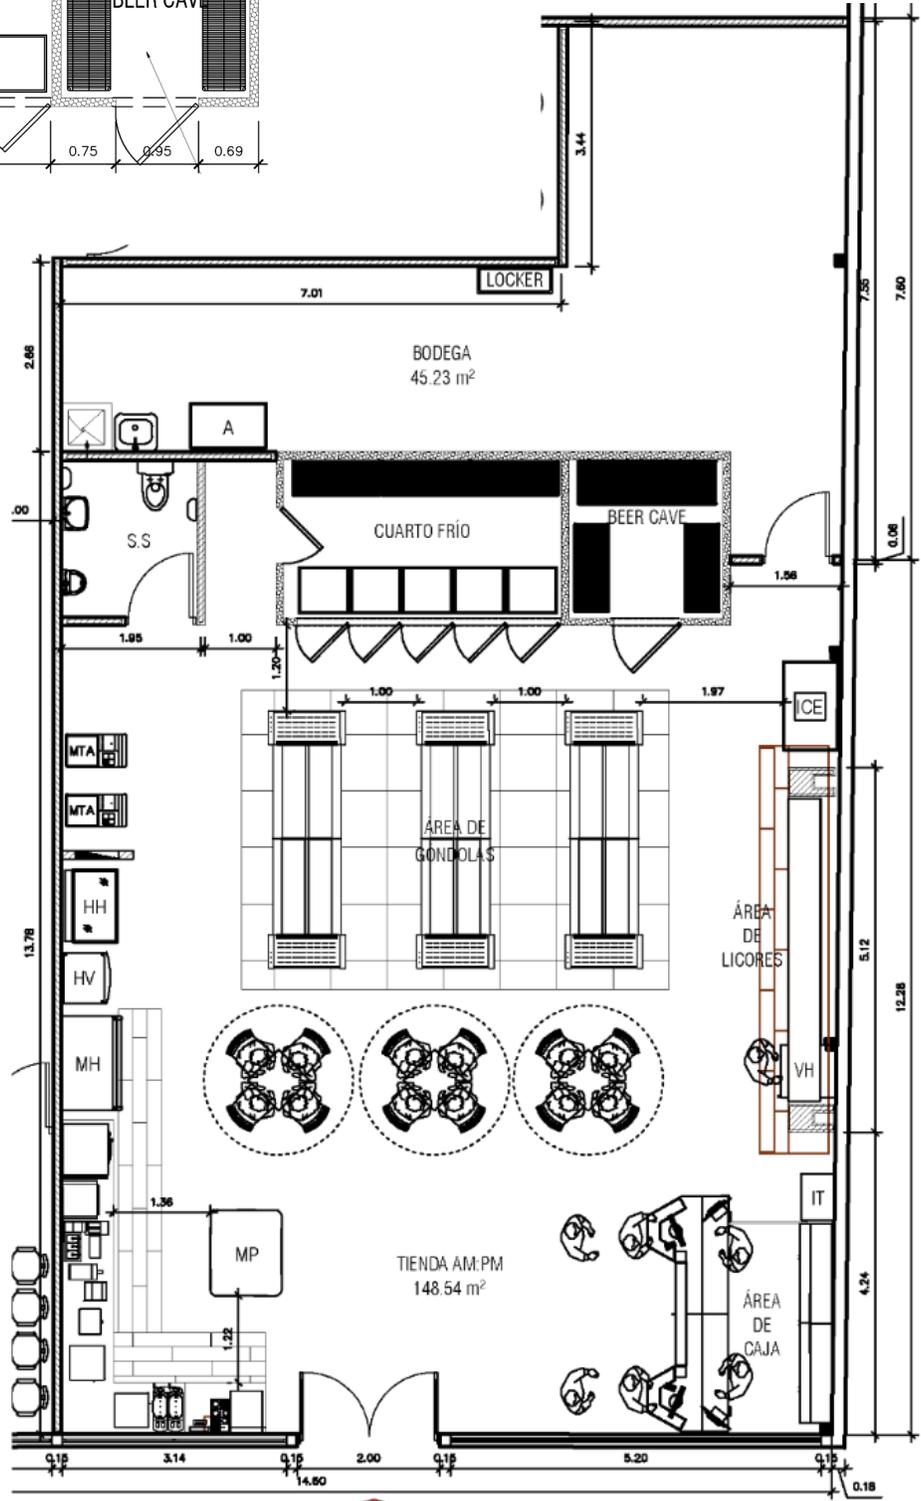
Layout de Planta de Propuesta y Cuarto Frío AMPM El Salvador No. 4, El Paseo, Escalón
